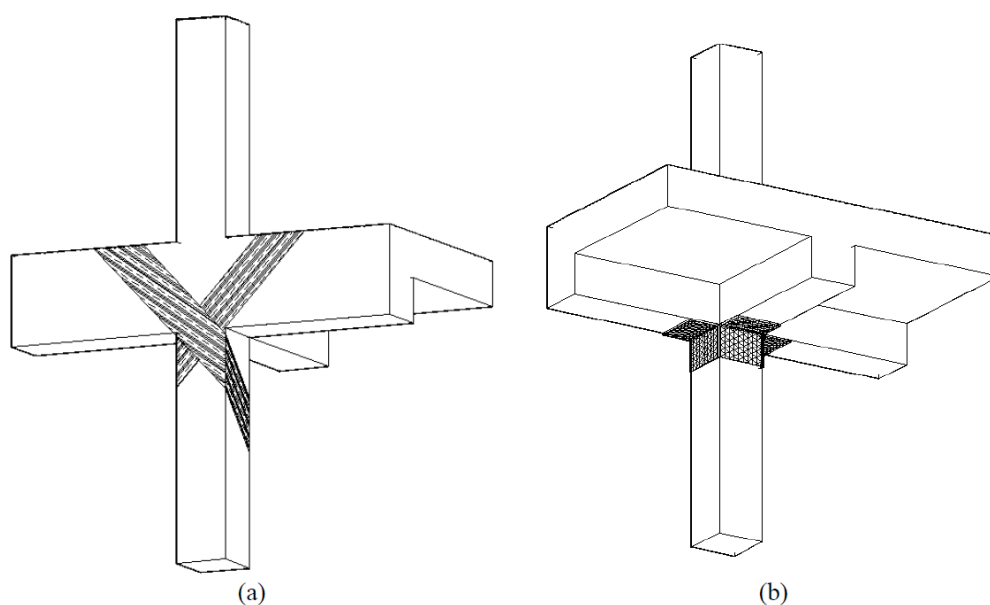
, Fasce diagonali con tessuto metallico unidirezionale su nodo intermedio: (a) vista esterna; (b) vista interna, Fonte: ReLuis “Linee guida per riparazione e rafforzamento di elementi strutturali, tamponature e partizioni”.
